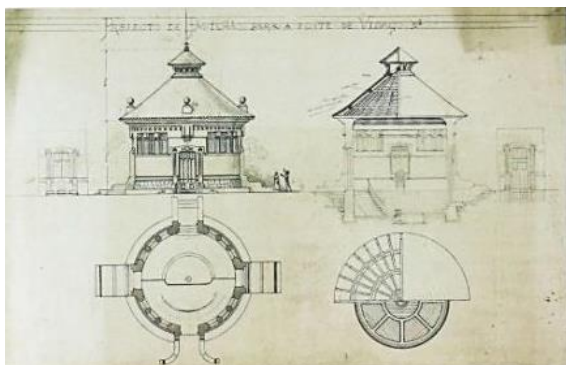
Termas do Vidago, António Rodrigues da Silva Júnior, alçado, corte e plantas do projecto de pavilhão para a Fonte de Vidago 2, [1909]
